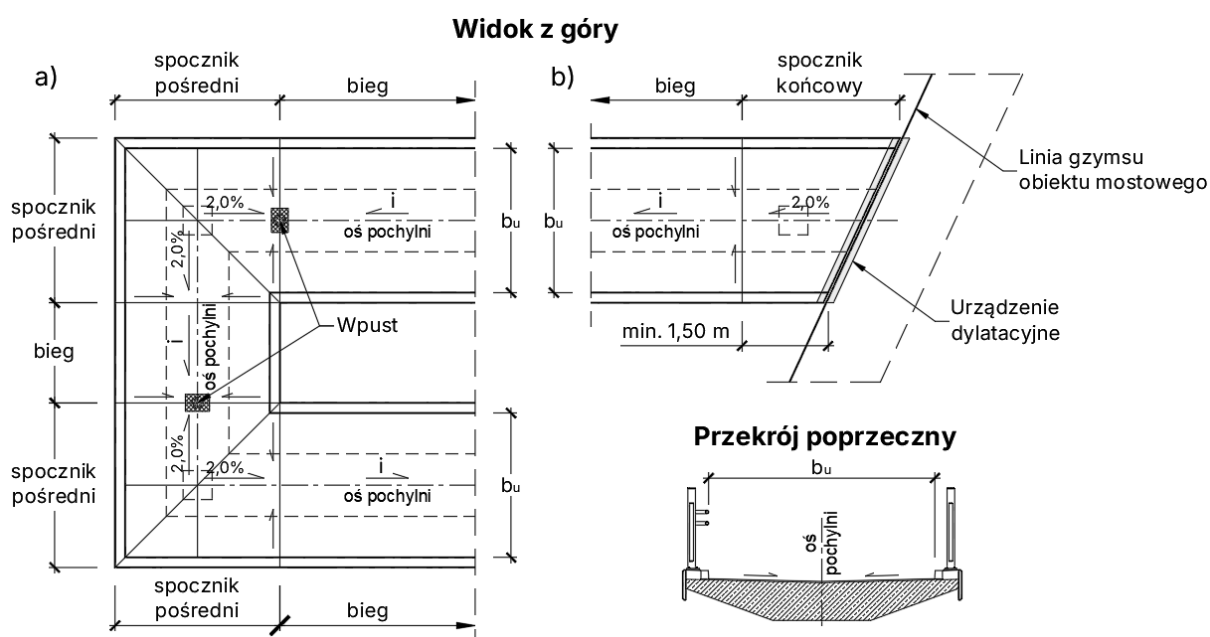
Zasady kształtowania pochylni przeznaczonych do ruchu pieszych
